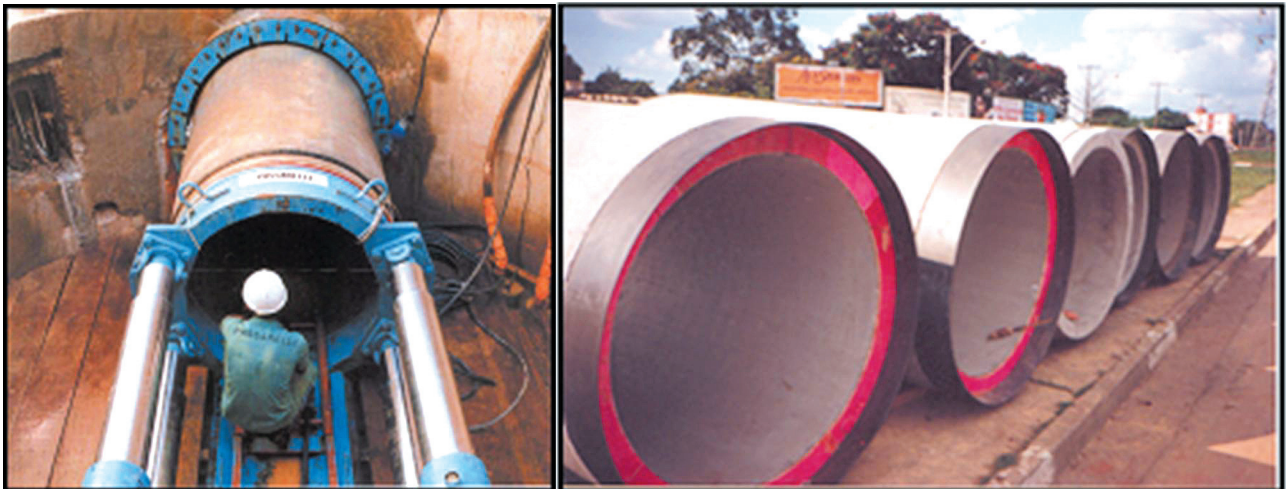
Tubos de Concreto para Sistema “Jacking Pipe”
